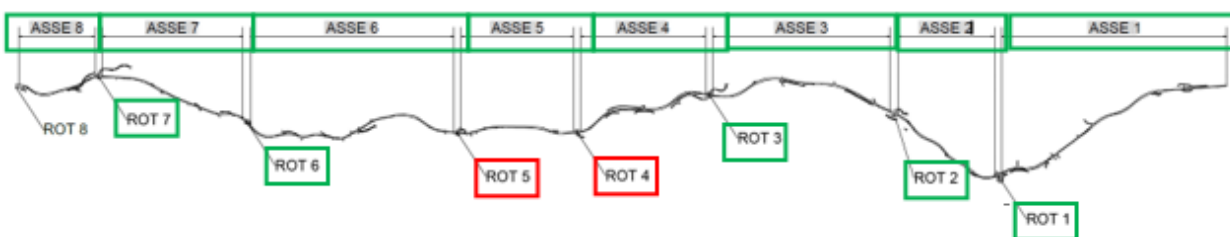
FASE 5 DI CANTIERIZZAZIONE
